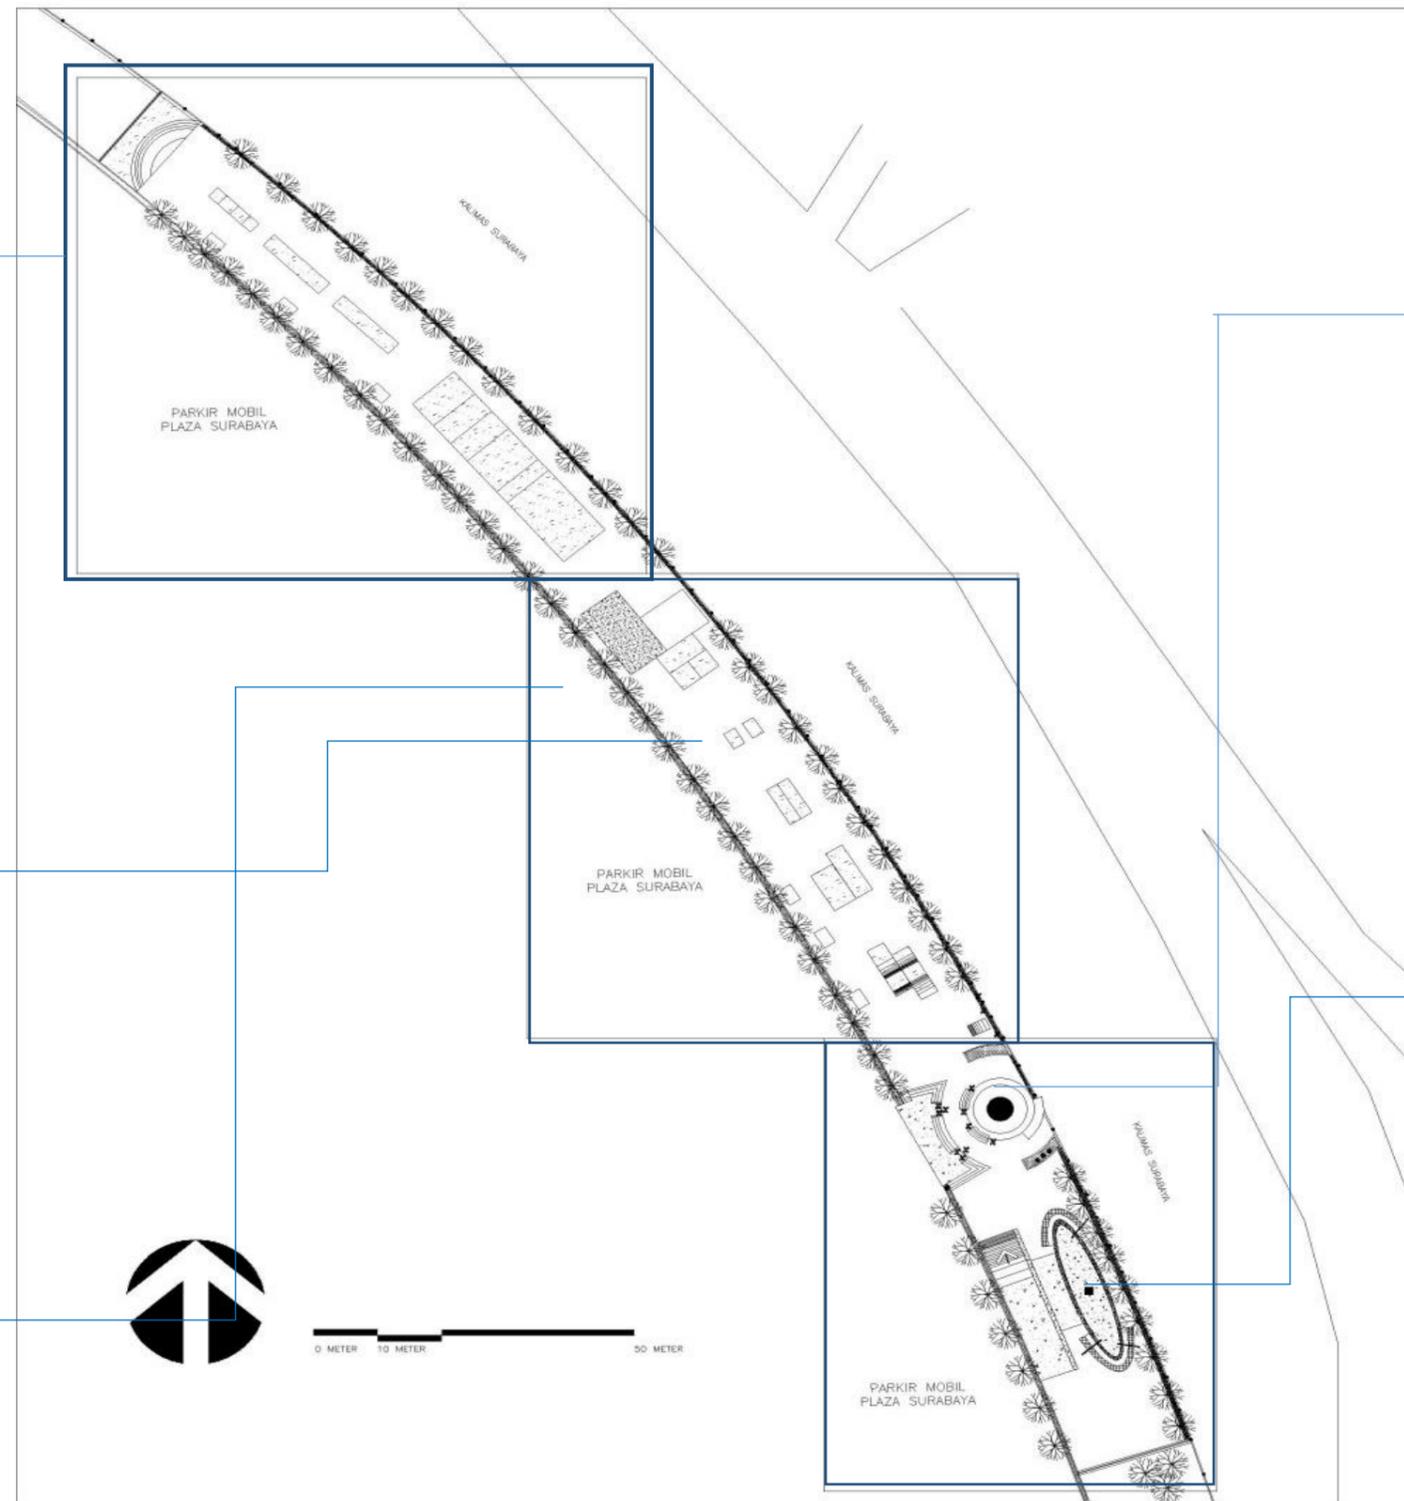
Layout Plan dan pembagian Segmen Taman Skate & BMX
